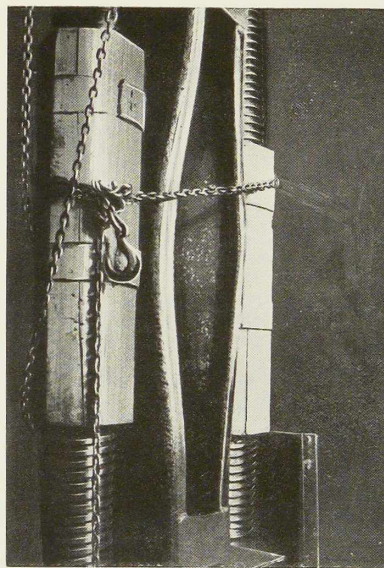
Essai de la membrure supérieure de la poutre principale.
